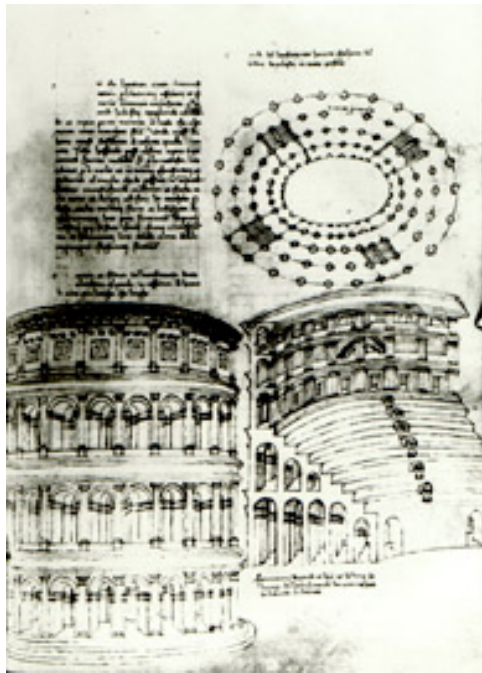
Francesco di Giorgio - Vista, corte e planta do Coliseu.
